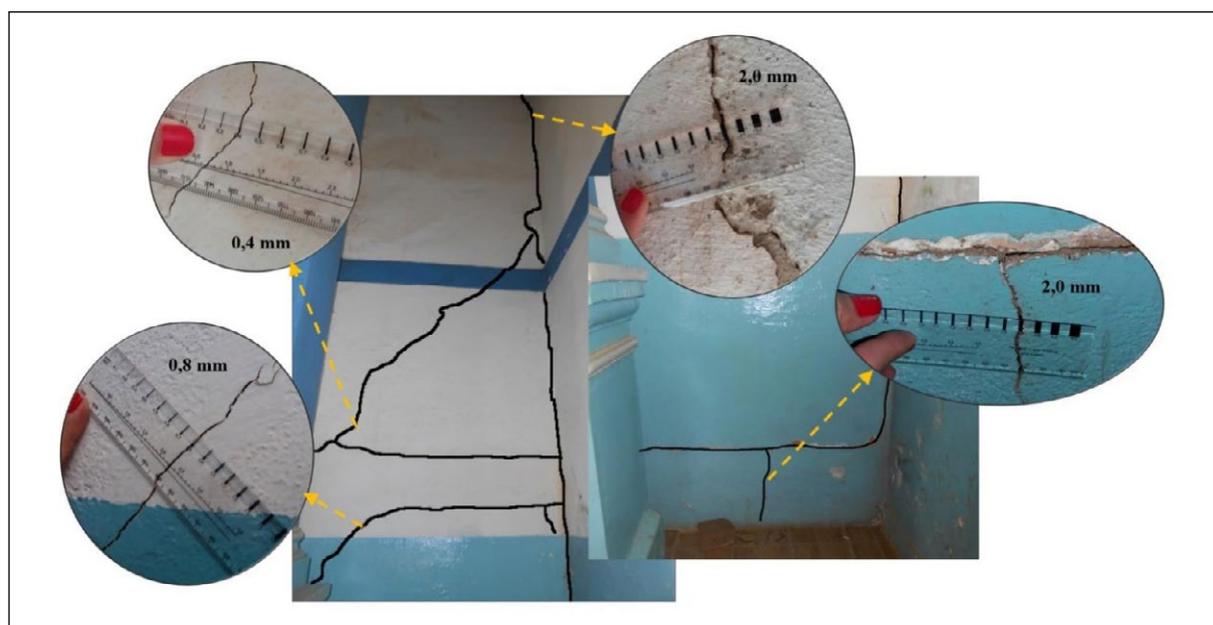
Internamente, conforme destacado na Figura 6, fissuras, trincas e rachaduras foram identificadas com espessuras variando de 0,4 mm a 2,0 mm. As fissuras se apresentam inclinadas, mas as trincas e rachaduras se evidenciam na posição vertical, ilustradas na Figura 6.
